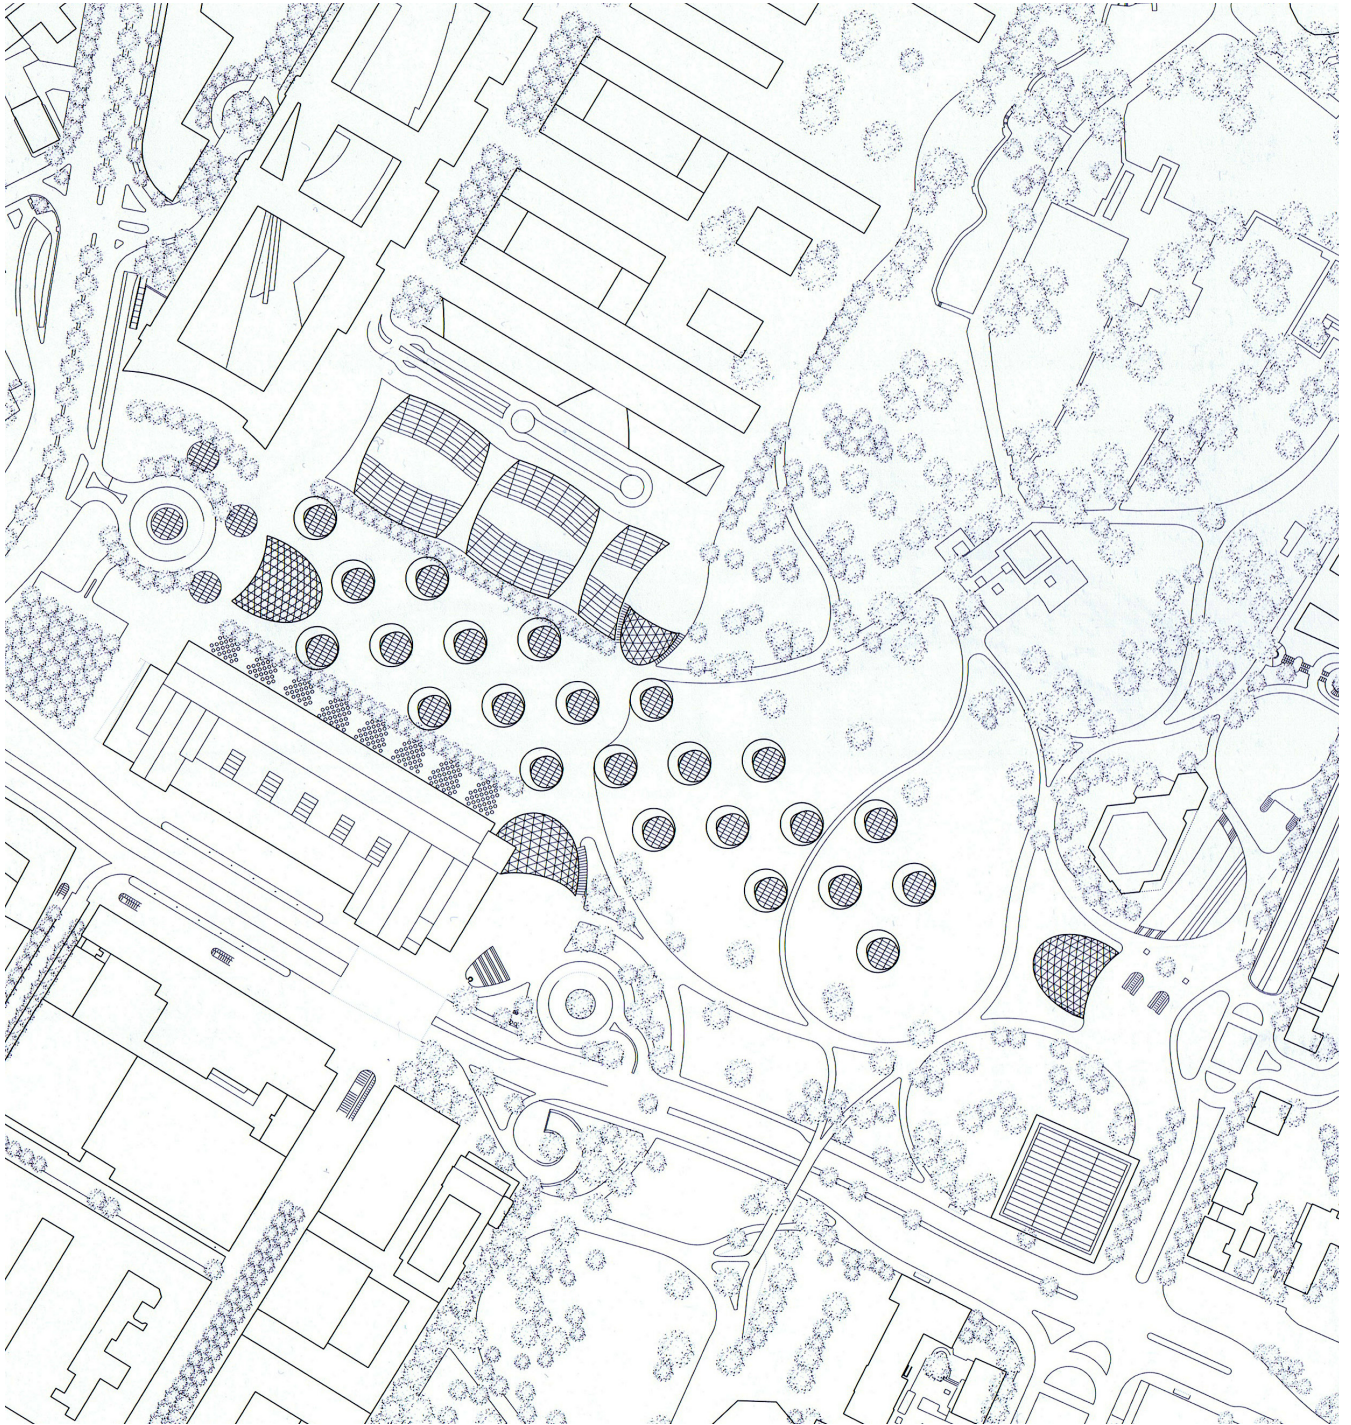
Bahnhof; Grundriss Platzgestaltung
